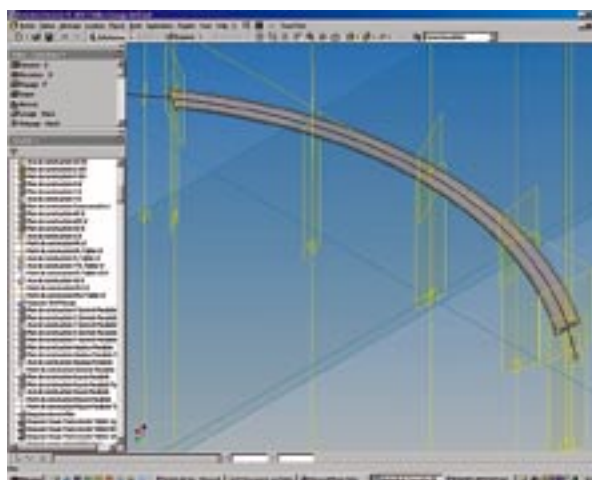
exemple de lissage d'un tablier de pont dalle suivant un rail
